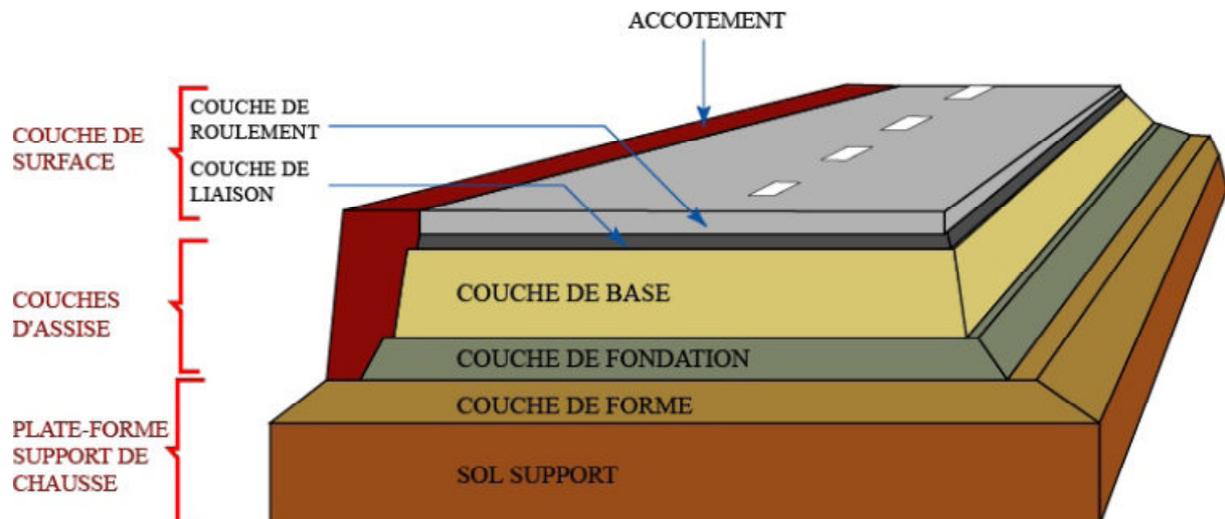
Coupe type d'une structure de chaussée et terminologie des différentes couches
